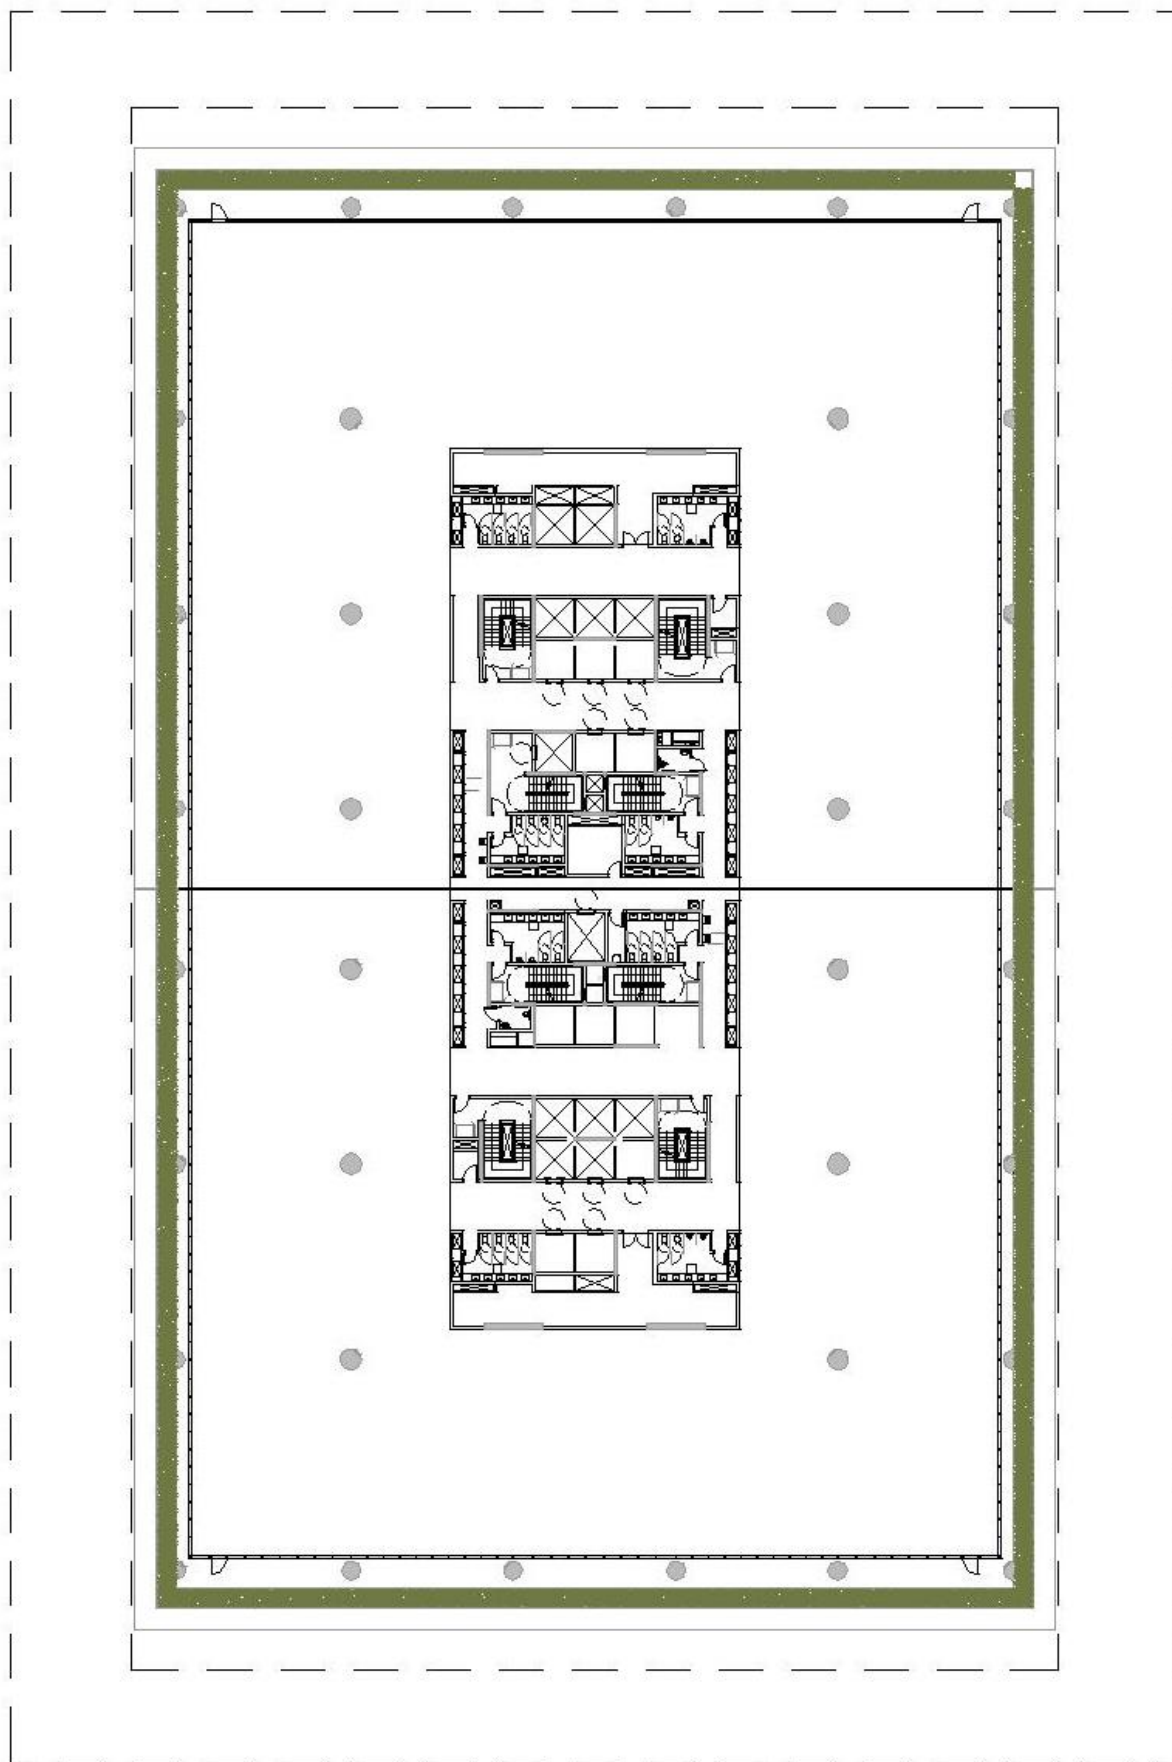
Variação B da planta dos pavimentos 1 ao 15.
